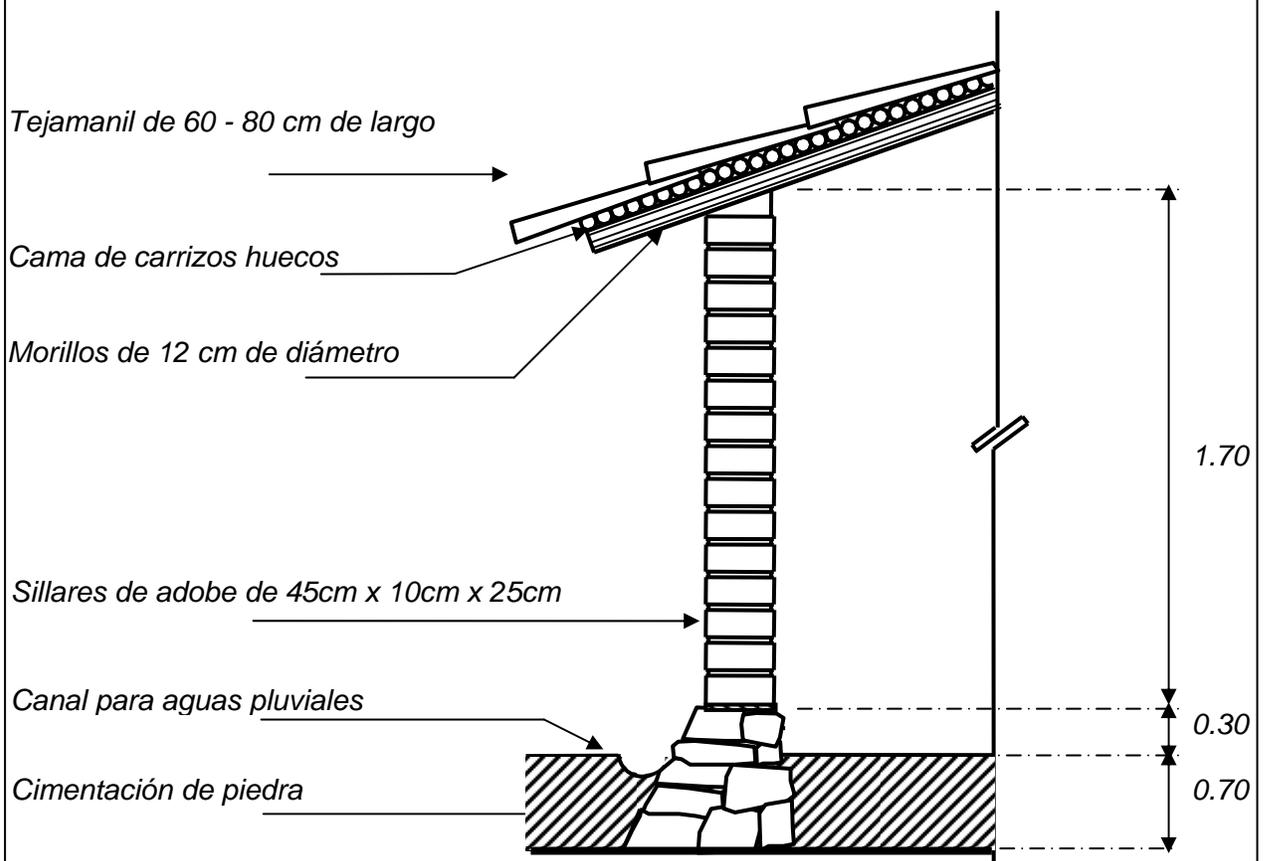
Sección de una vivienda convencional de la sierra norte de Oaxaca. Se aprecia un muro de adobe desplantado sobre piedras del mismo terreno, la cubierta es de tejamanil sobre madera; el piso en estas viviendas era de tierra apisonada. (d.a.)
